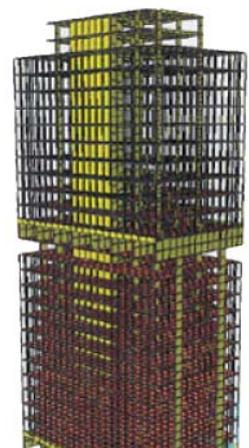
Konstruktionszeichnung mit Lage der technischen Etage (Quelle: OTEP und CONSTRUCCIONES ORITZ, Spanien)
